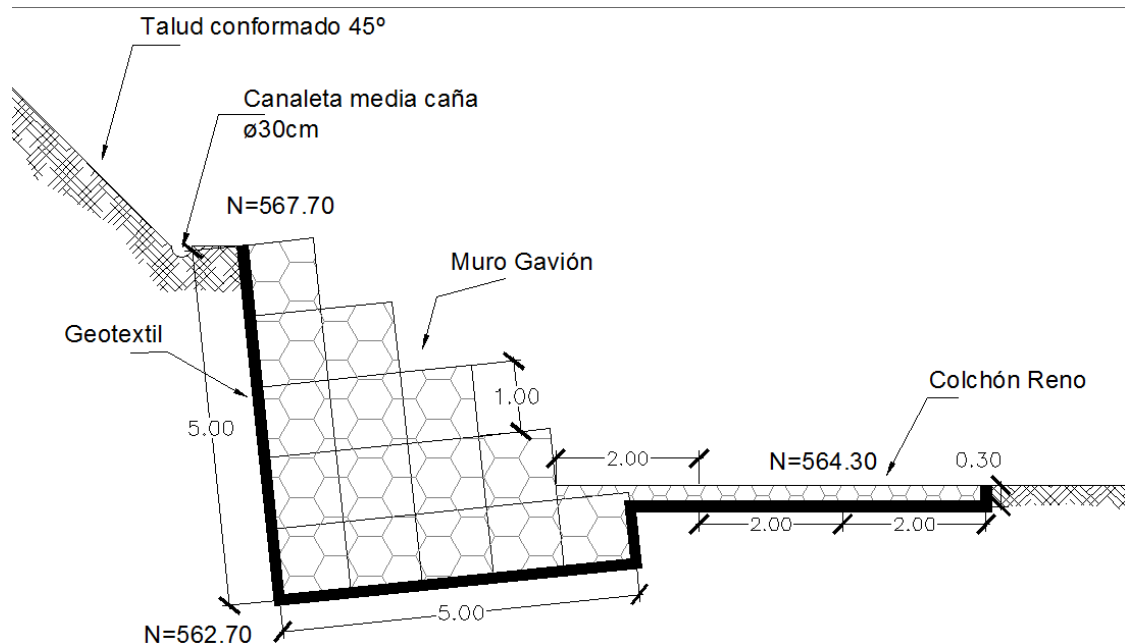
Detalle del muro gavión de la Propuesta de Alternativa de Solución N°1, sin escala.
